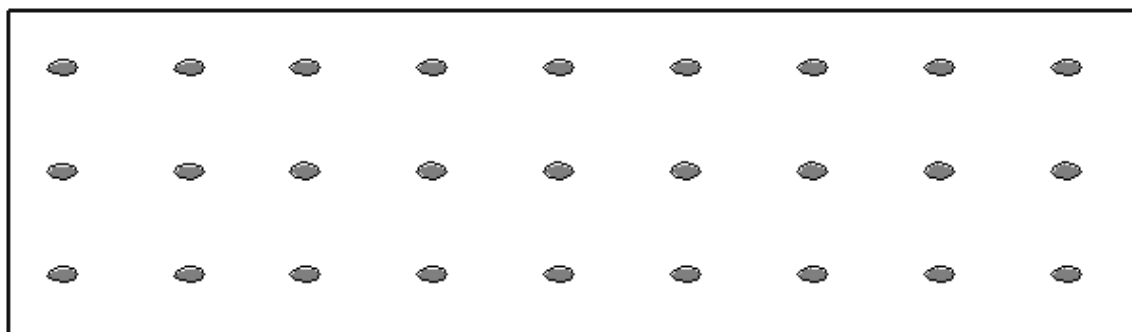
Шаг 2. Нанесение пены монтажной точечным способом на плиту GB-600F (GB-600)
